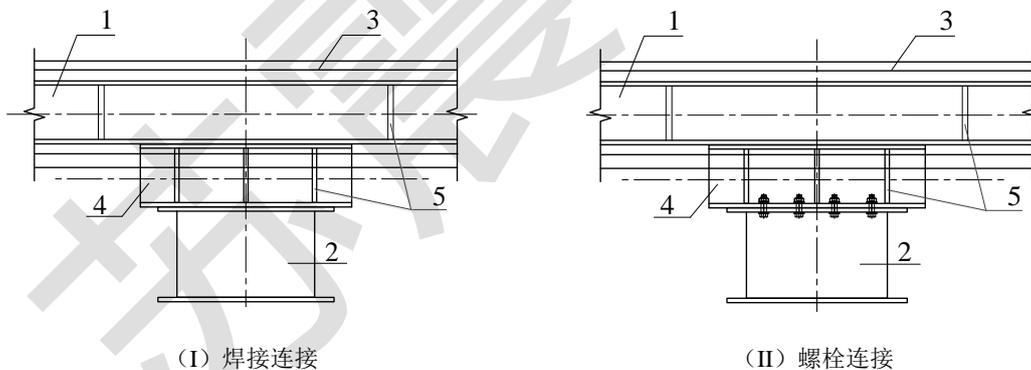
墙式金属阻尼器与型钢混凝土组合结构梁的连接构造
